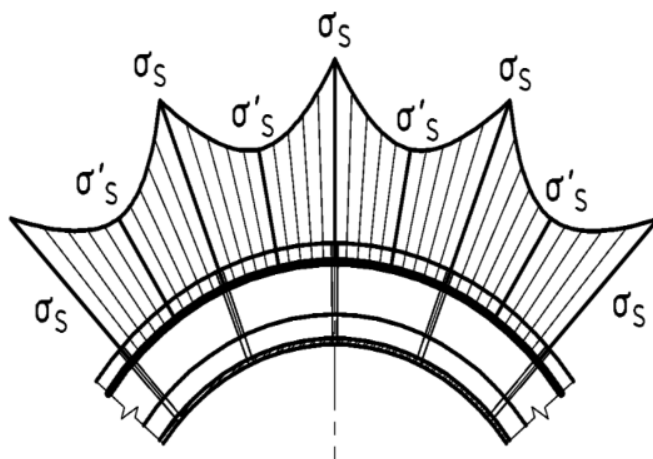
Эпюра напряжений в кольцевой арматуре сталежелезобетонной обделки высоконапорного туннеля
